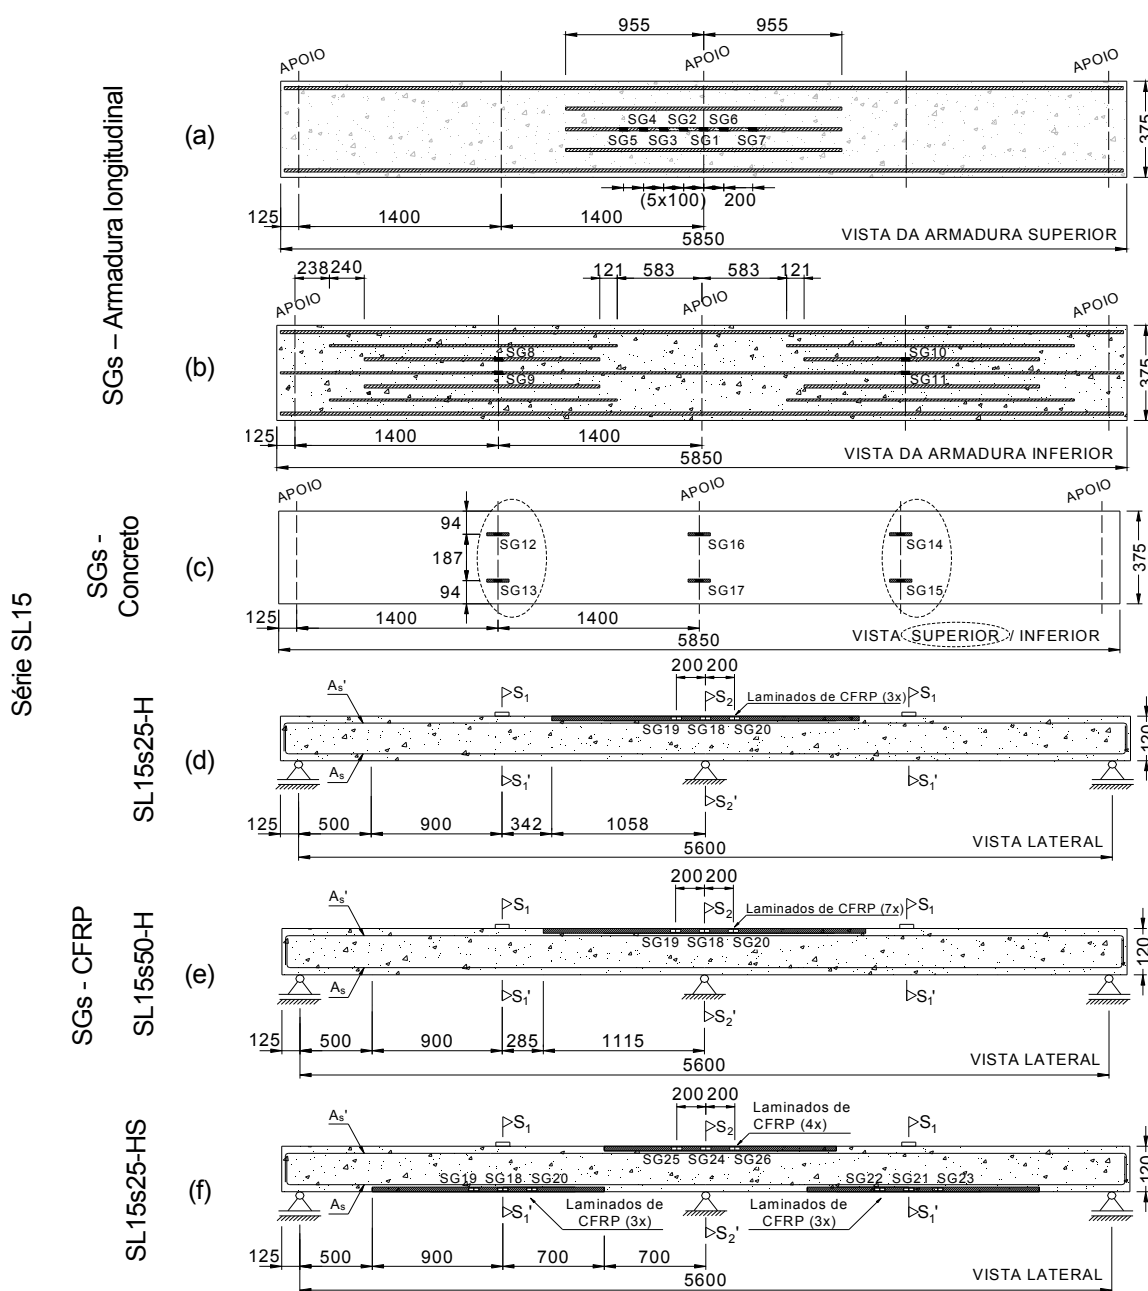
Posicionamento de (a-b) extensômetros (SGs) nas armaduras longitudinais, (c) concreto, (d-f) laminados de CFRP para as faixas de laje reforçadas da série SL15 (dimensões em mm).
